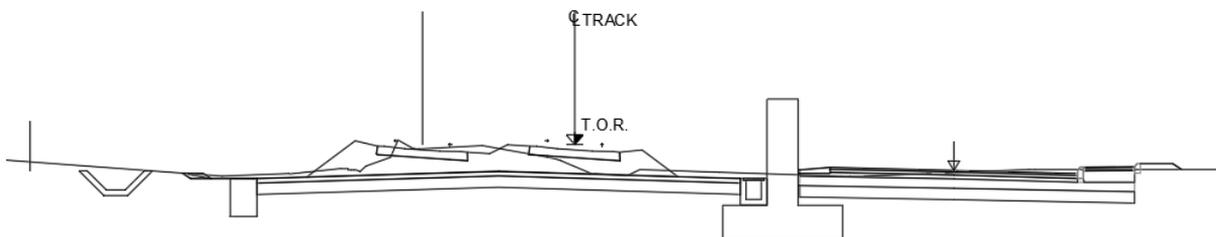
Sezione tipo situazione di progetto Via Vibrata
